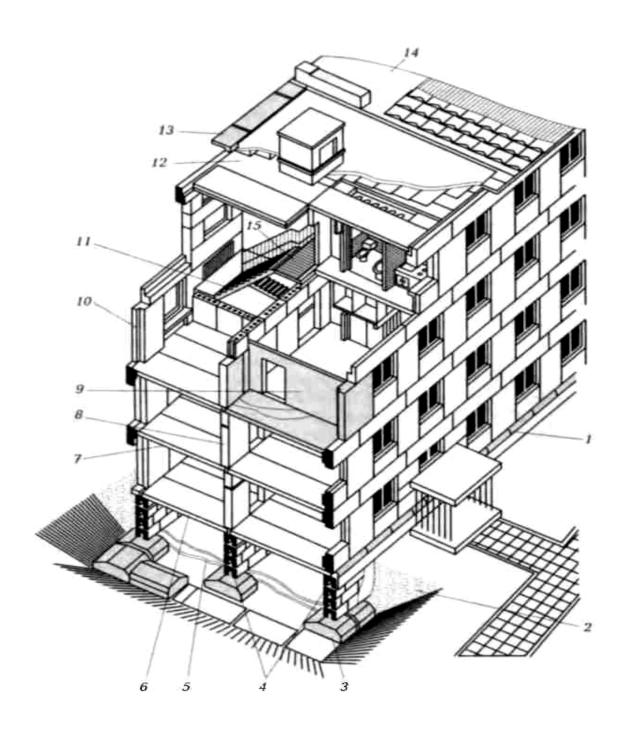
Конструкции гражданского здания: 1 — цоколь; 2 — гидроизоляция; 3 — фундамент; 4 — стена подвала; 5 — пол подвала; 6 — надподвальное перекрытие; 7 — междуэтажное перекрытие; 8 — внутренняя стена; 9 — перегородка; 10 — наружная стена; 11 — лестничный марш; 12 — совмещенная крыша; 13 — карниз; 14 — рулонная кровля; 15 — лестничная площадка
